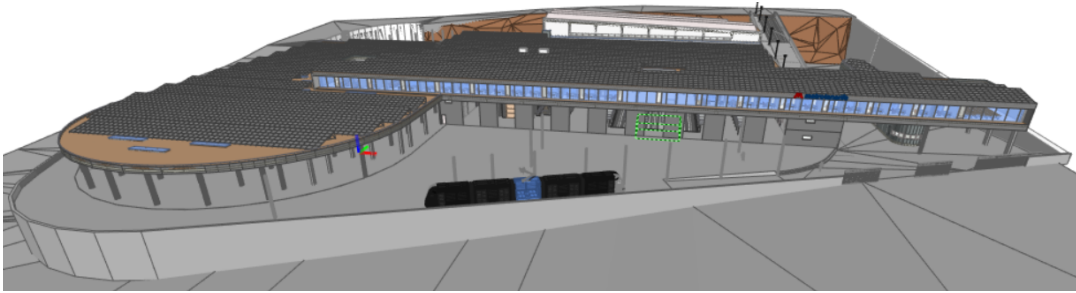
Planta de Cubierta en aplicación BIM Vision Elaboración Propia.
